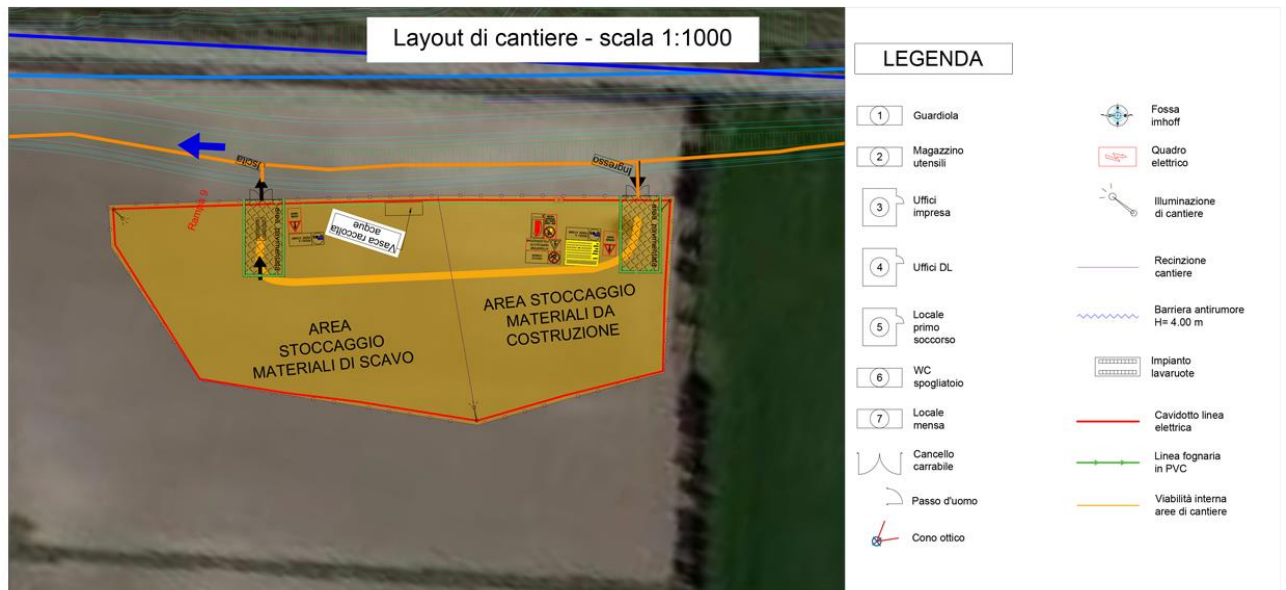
Stralcio planimetrico AS3 Area di stoccaggio 3
